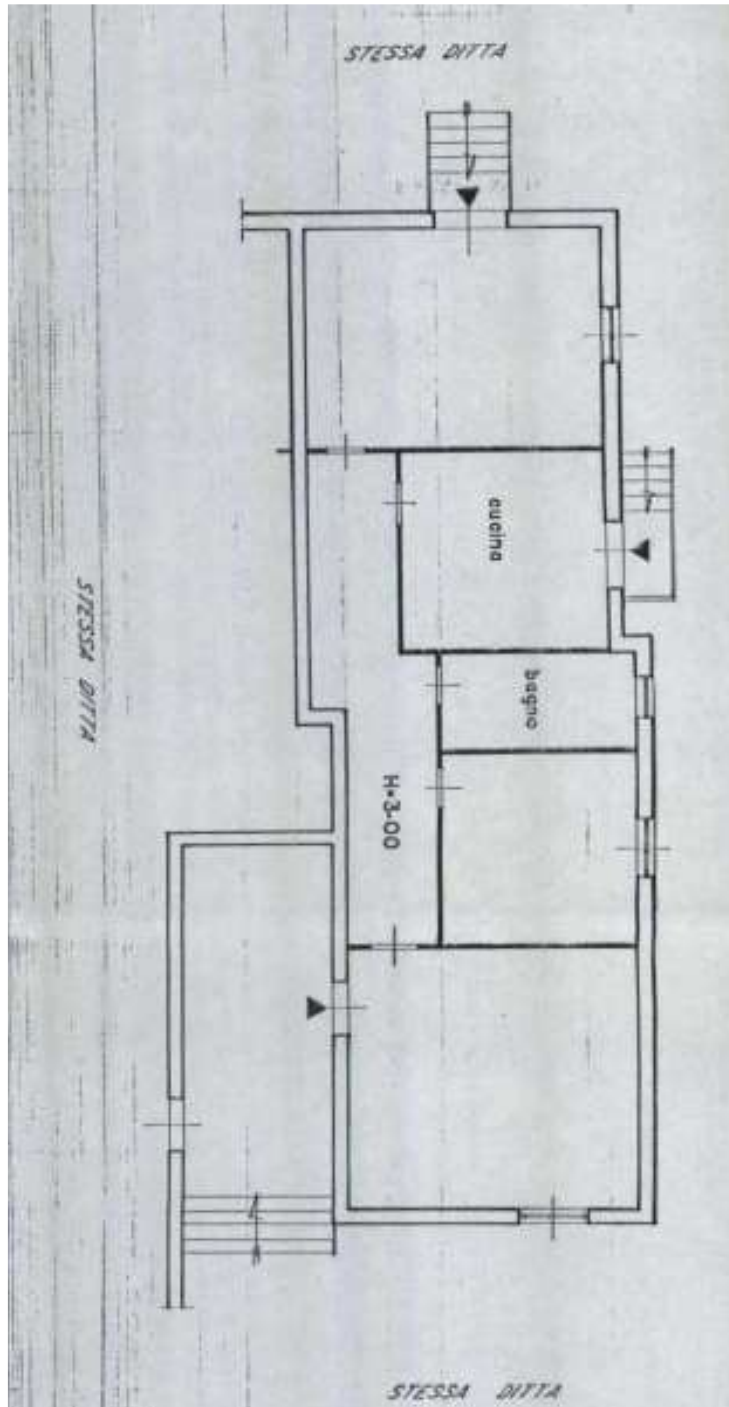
In questa planimetria non è presente il terrazzo dove in seguito è stata realizzata la cucina
